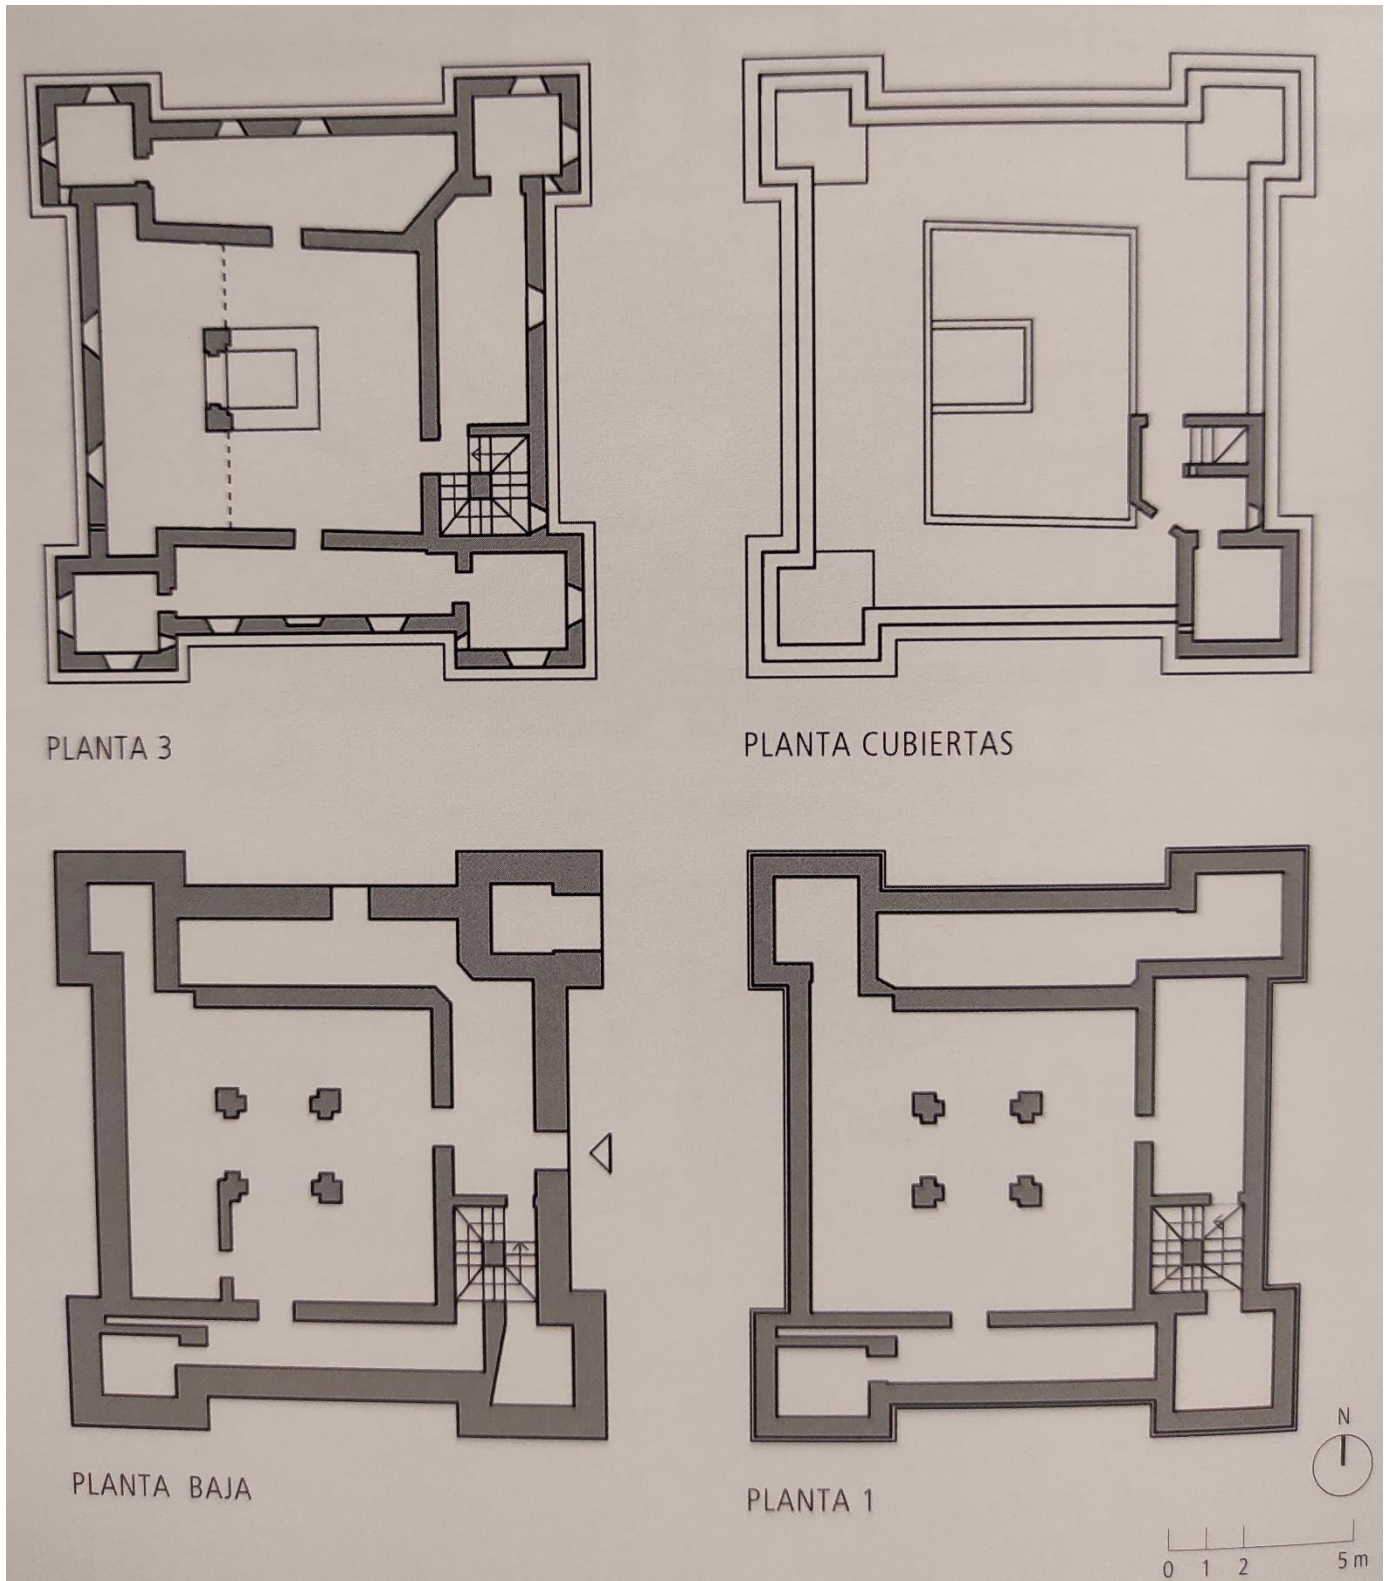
Tighremt Ait Abou, plantas baja, primera, tercera y de la cubierta.
